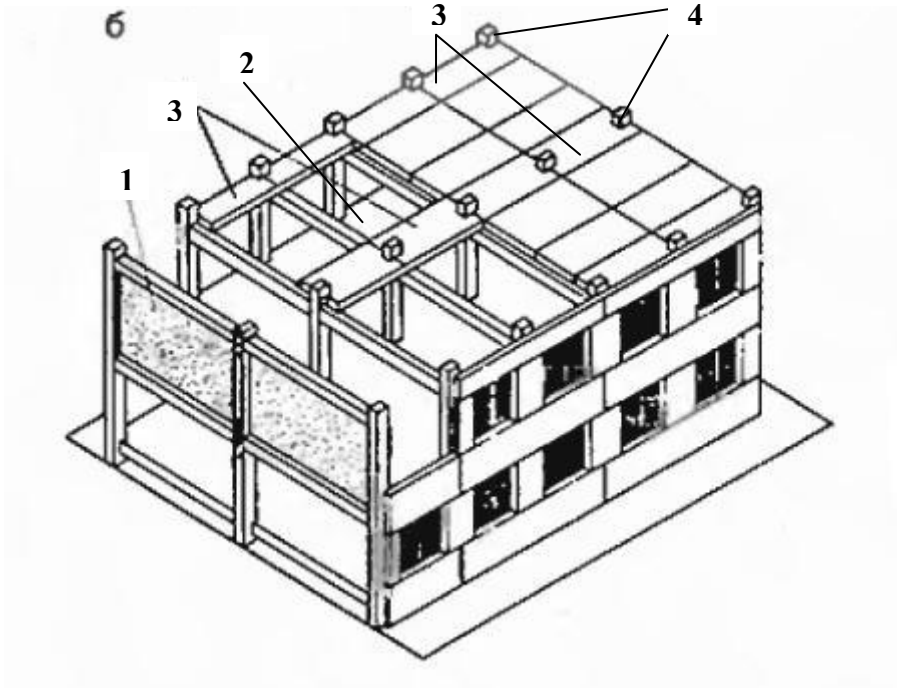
Элементы, обеспечивающие пространственную жесткость каркас зданий
